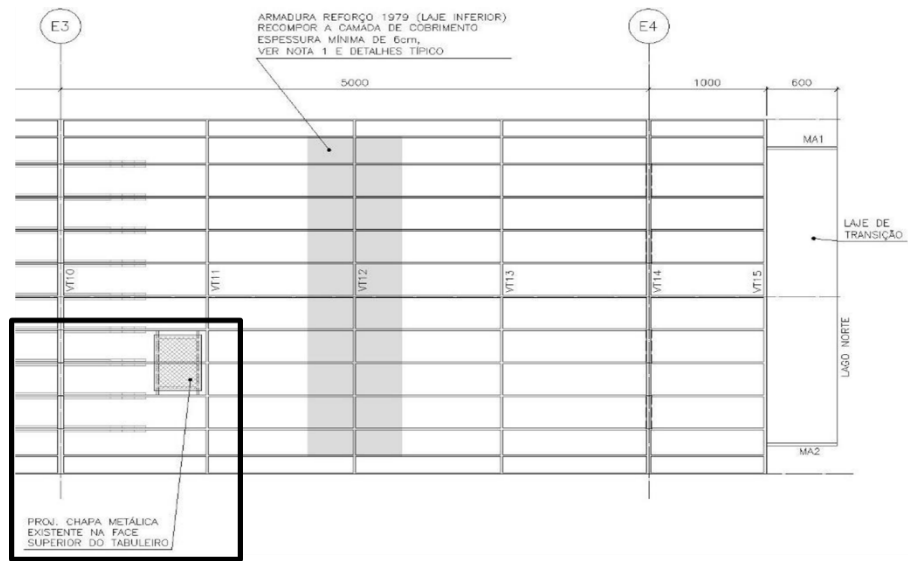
Laje Superior do Tabuleiro – Eixos E3 a E4 Chapa Metálica p/ Vedar Furo Existente na Laje
